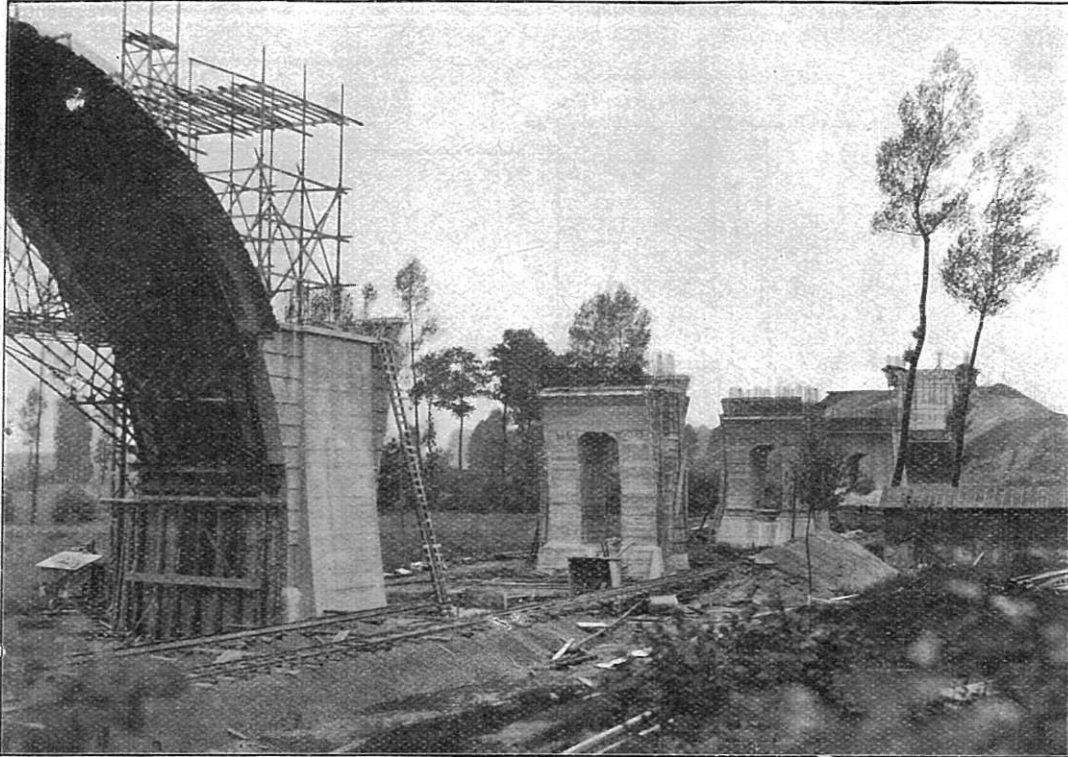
Viaduc de la Pède. — Piles bétonnées.
